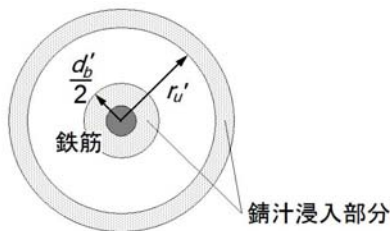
鉄筋の腐食による内部ひび割れのイメージ
